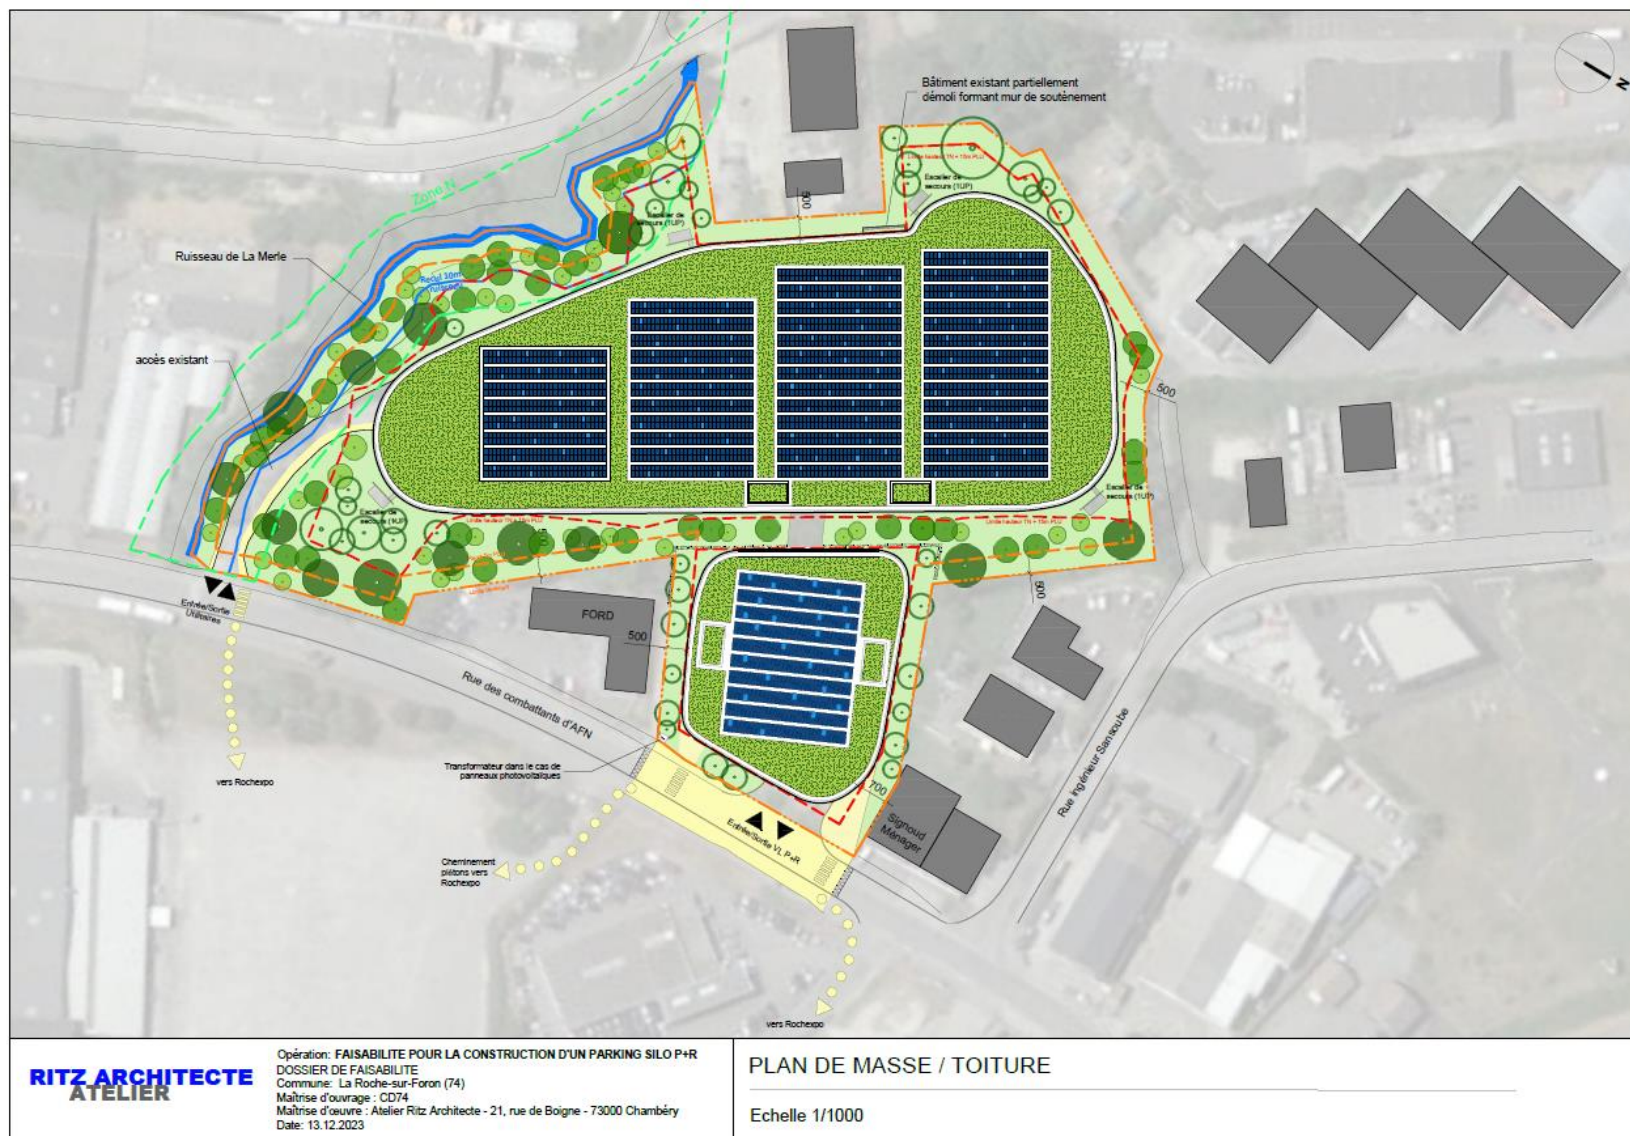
Plan de masse du parking en silo (Source : Ritz Architecte)
